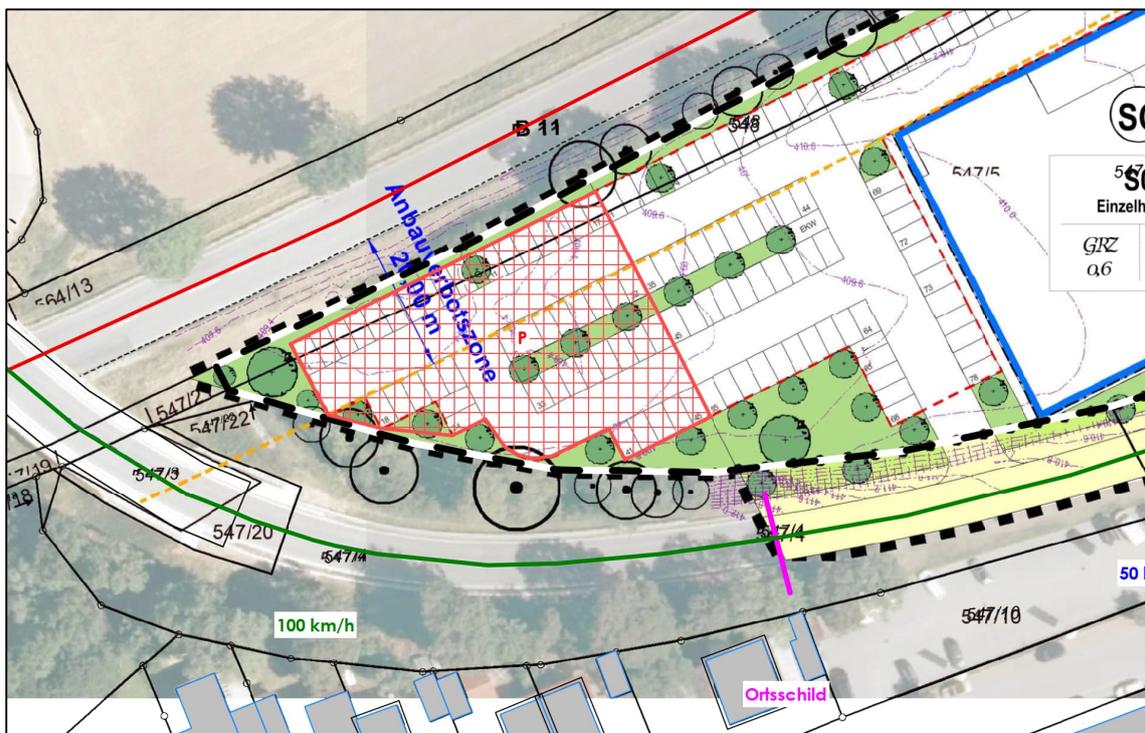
Lageplan mit Darstellung öffentlicher Parkfläche (P) im Geltungsbereich
